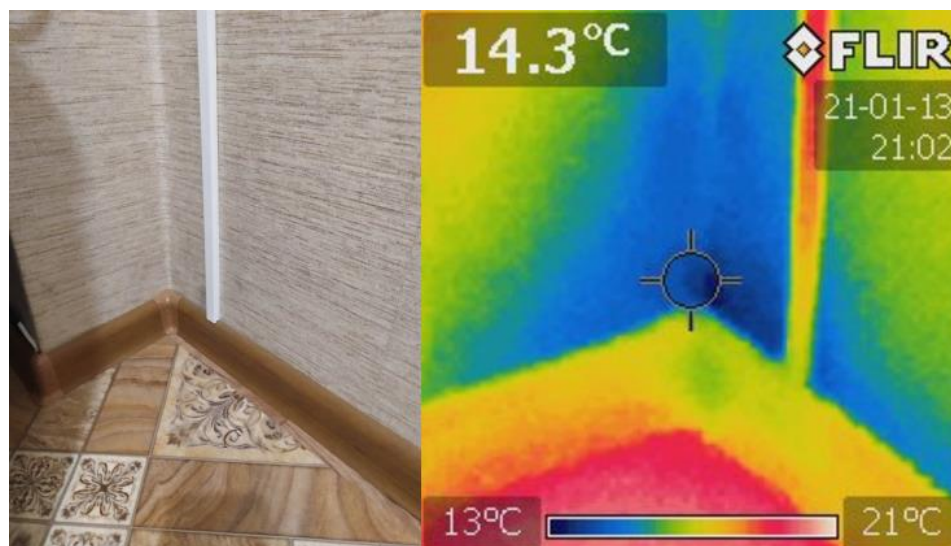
Термограмма стыка наружной стены и межэтажного перекрытия панельного дома (фото авторов)
